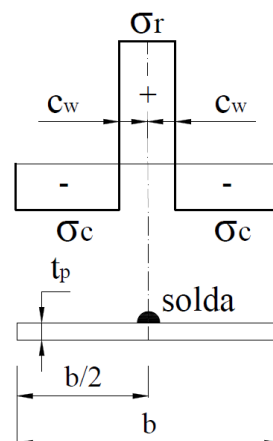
Modelo proposto para tensões residuais em placas com soldadura.
